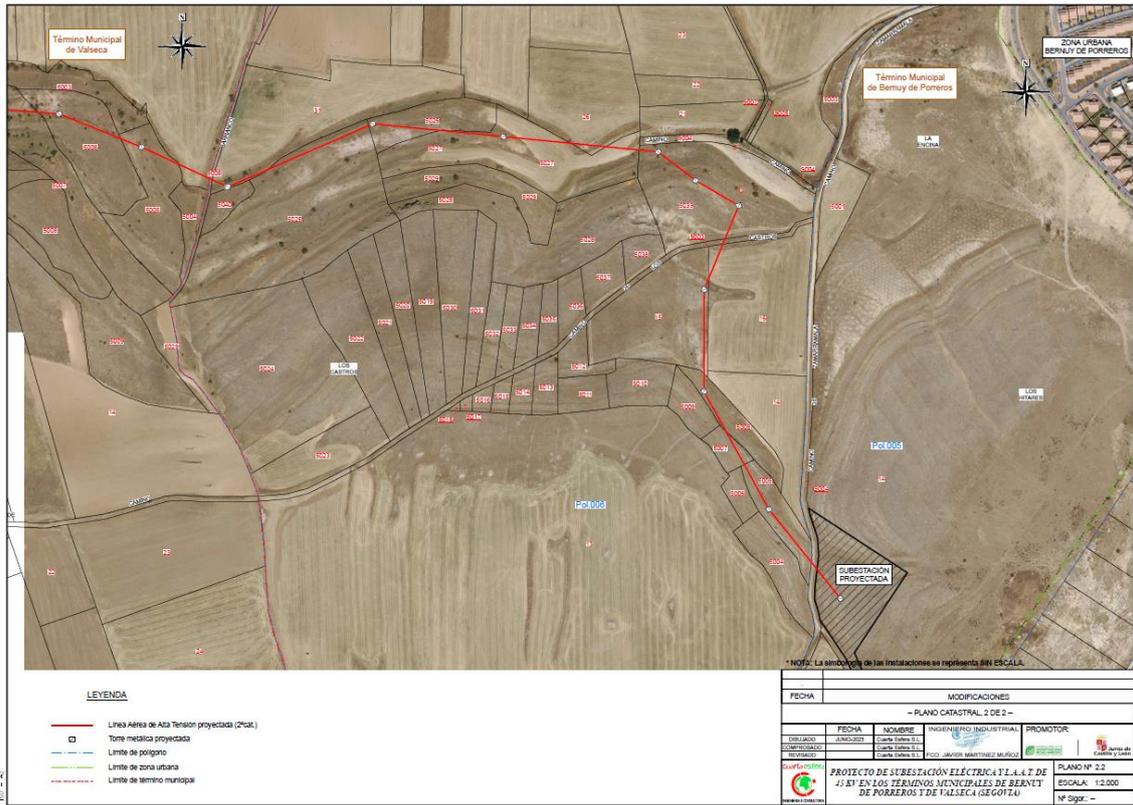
Plano de línea eléctrica prevista y localización de la subestación eléctrica en el ámbito del PRAT.
